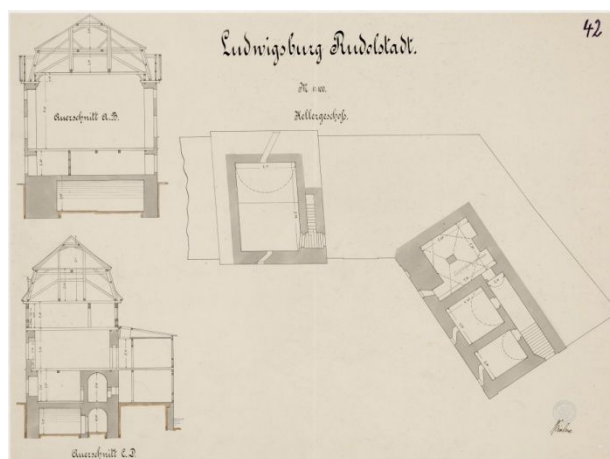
Ludwigsburg – Grundriss des Kellergeschosses im Mittel- und Nordflügel mit Querschnitten (undatierter Entwurfsplan, vermutlich vor 1734).
